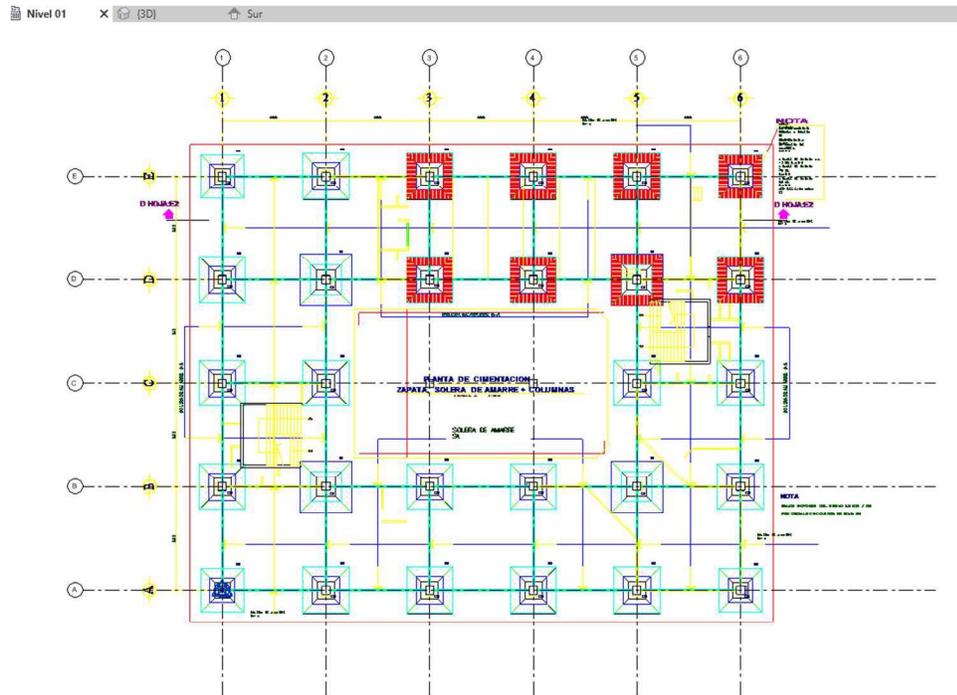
Planta de columnas estructurales del primer nivel en AutoCAD
